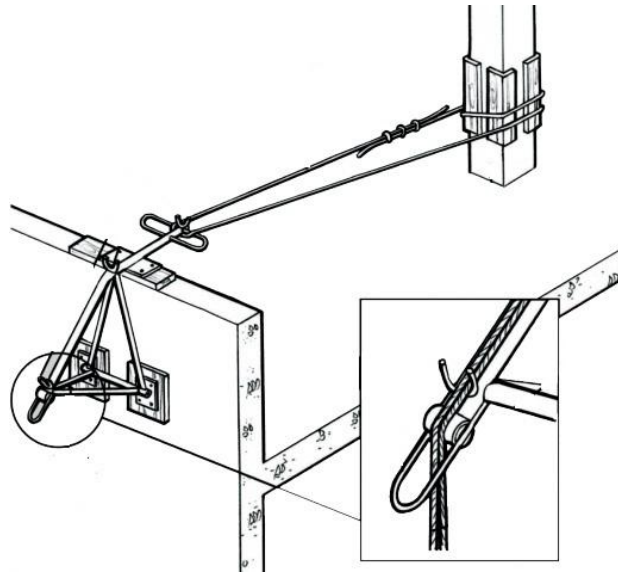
Fixação de andaime suspenso com afastador metálico.
